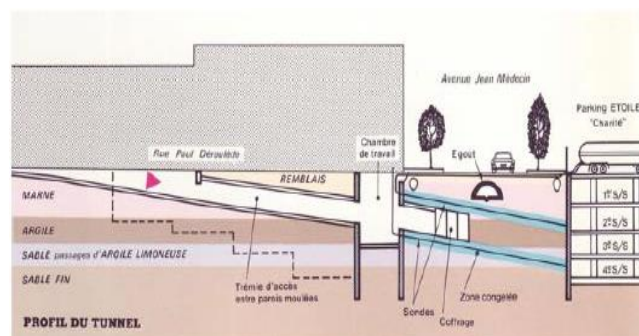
Traitement par congélation à Nice d'une zone sous chaussée traversée en tunnel
